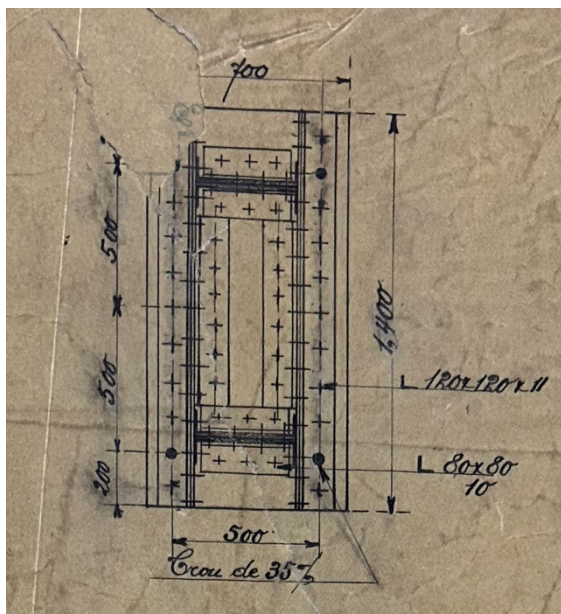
Coupe d'une colonne principale, Exposition de Bruxelles 1910
